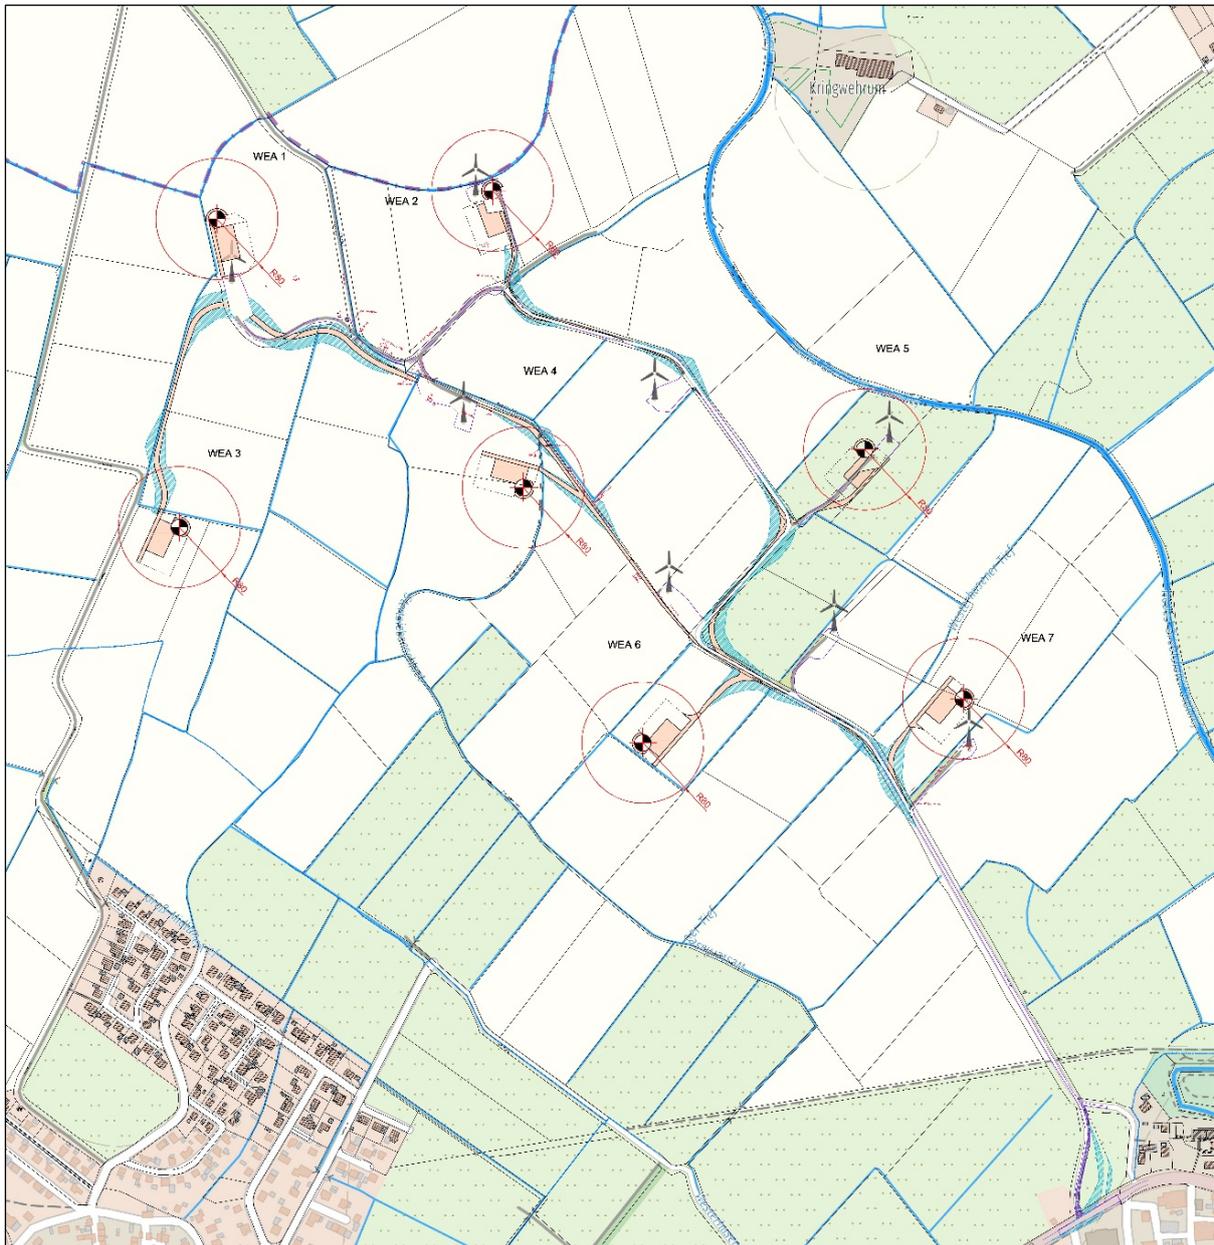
Lageplan der geplanten WEA mit Zuwegungen (Stand 18.12.2023)
